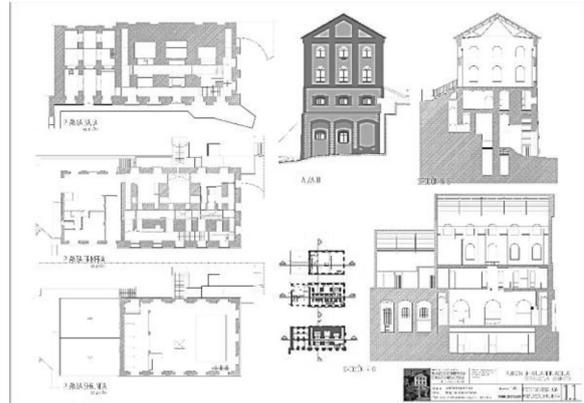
Secciones restituidas del estado actual para el levantamiento de lesiones y diagnóstico del edificio.
